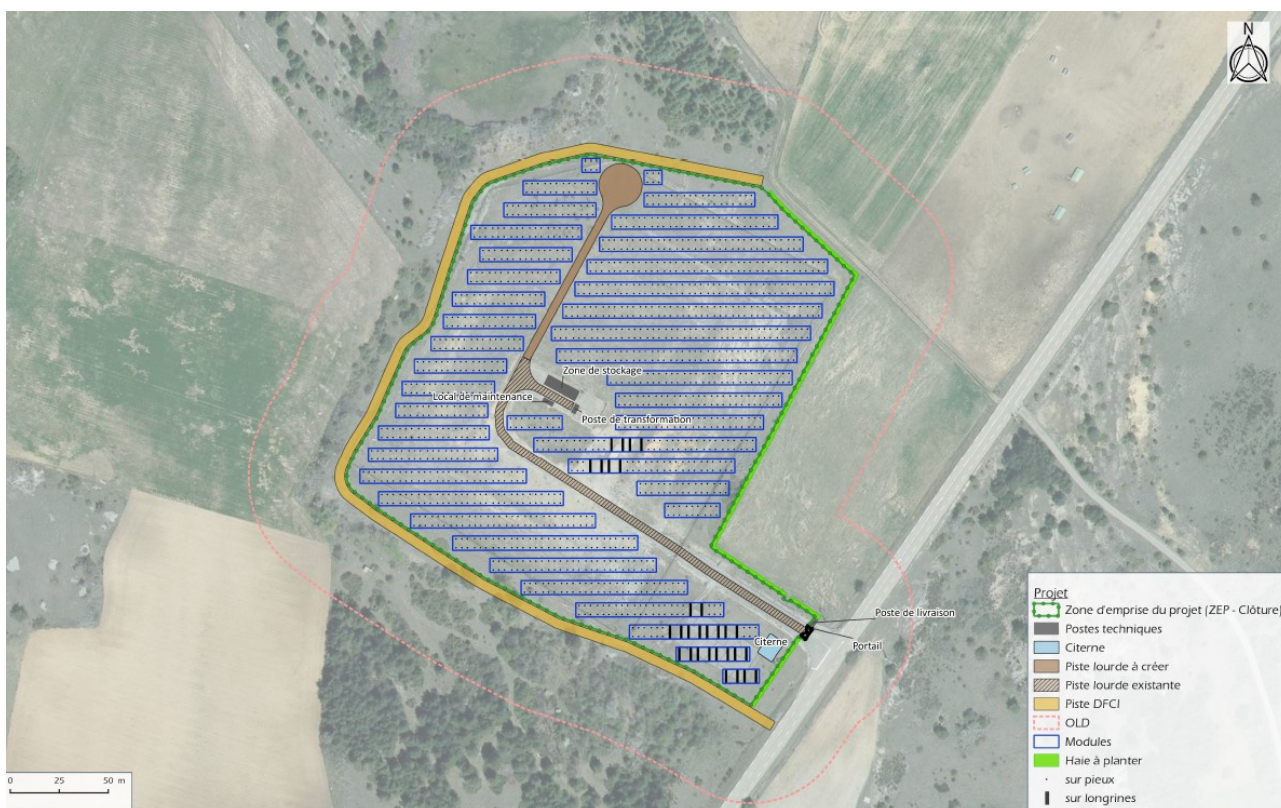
Plan masse (source : p. 167 de l'étude d'impact)
